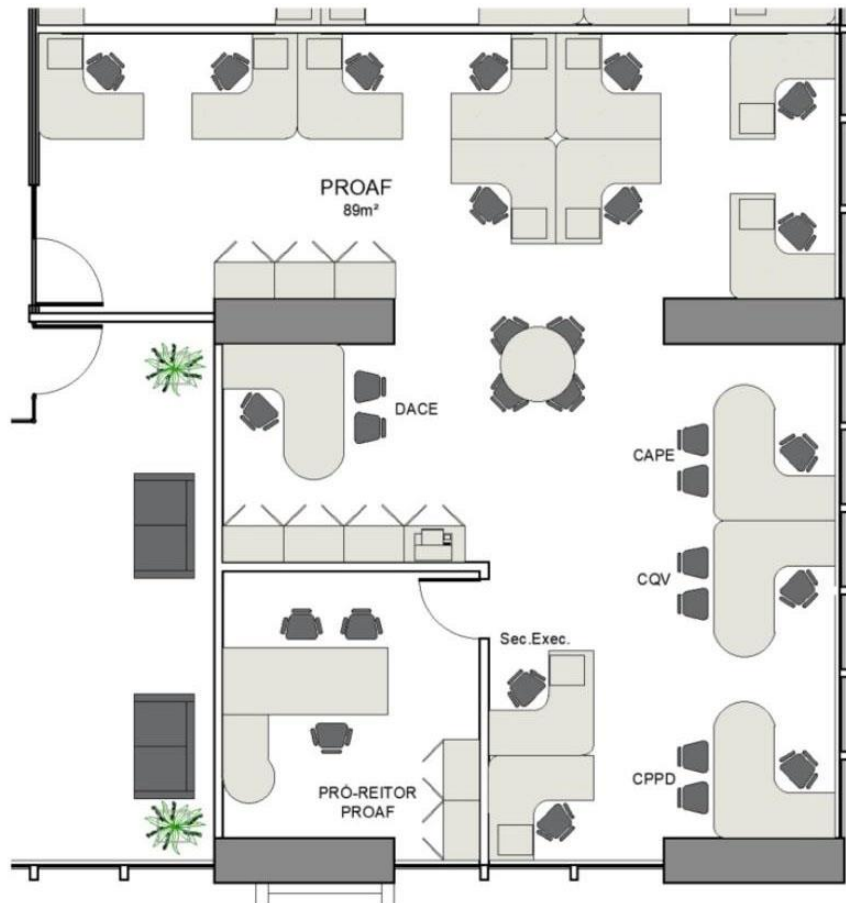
Layout salas PROAF - Pavimento 1, prédio Reitoria/UFESB
